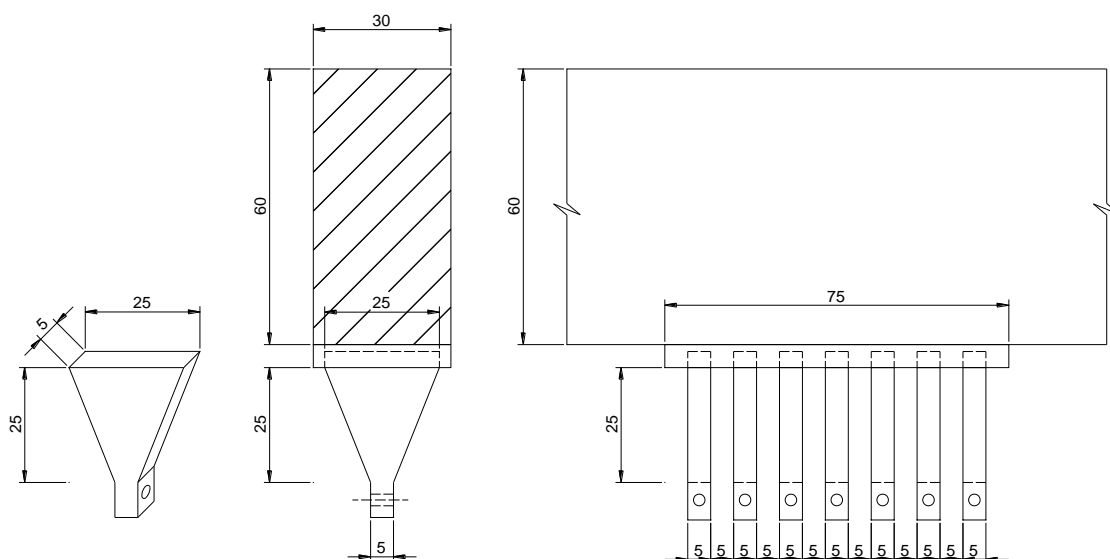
Detalle de planchas triangulares del disipador TADAS
